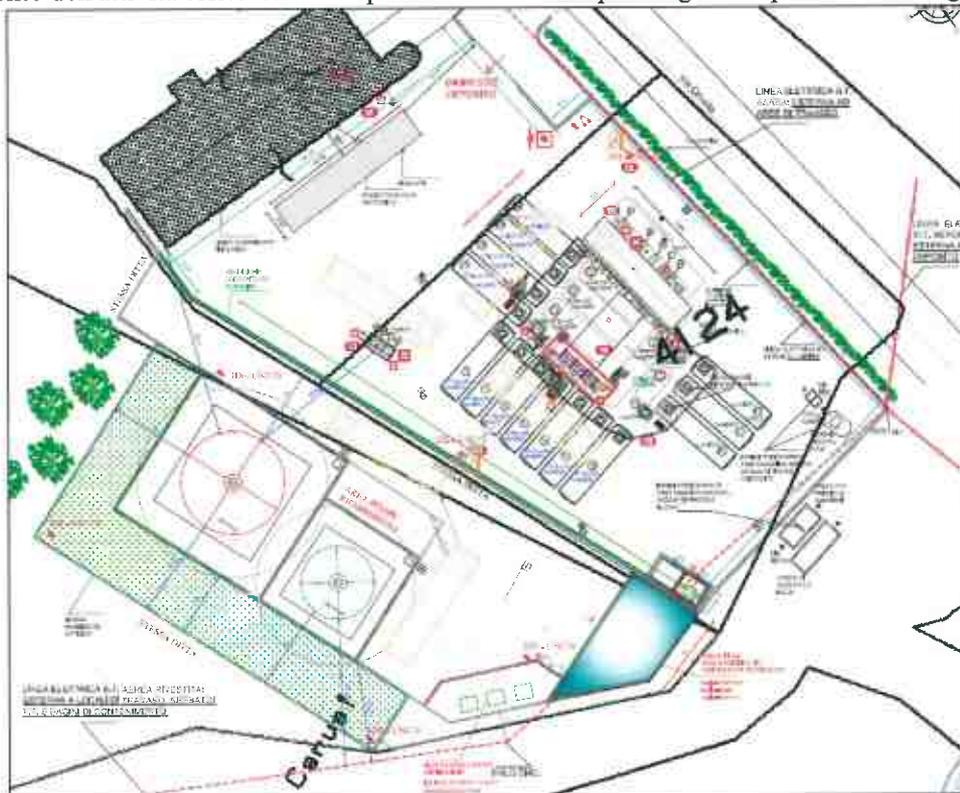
Planimetria di progetto (da Elab. T5 allegato allo SPA)
